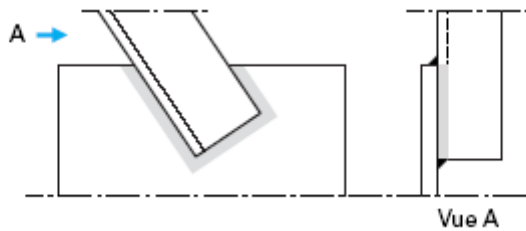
Cornière attachée par soudure (zone grisée) sur un gousset
